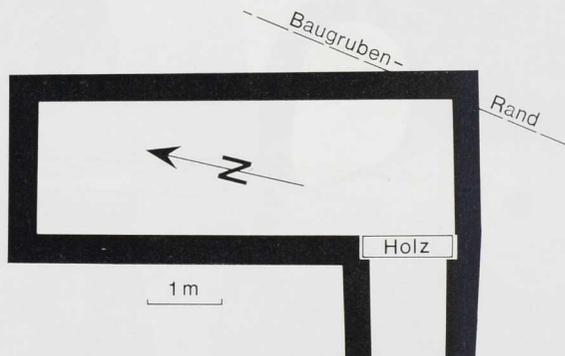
Endersbach (Lkr. Waiblingen). Grundriß eines römischen Kellers.
